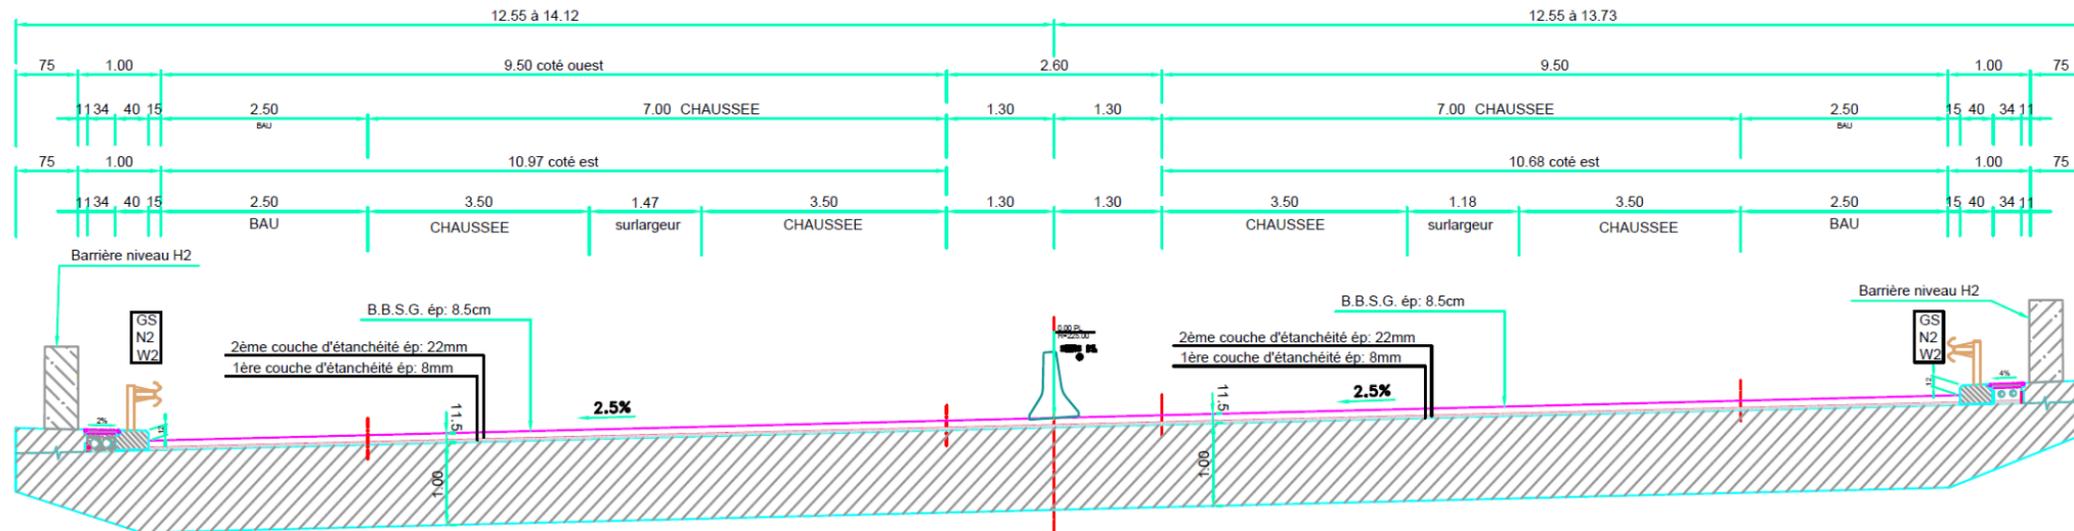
Coupe transversale de l'ouvrage d'art OA2
